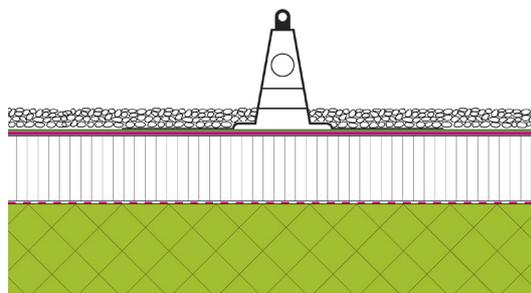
Classe di equipaggiamento 1; PAS installata su un tetto piano isolato termicamente, variante appesantita dal substrato sull'impermeabilizzazione. (Osservare le istruzioni del produttore, chiarire l'idoneità all'inverno).
